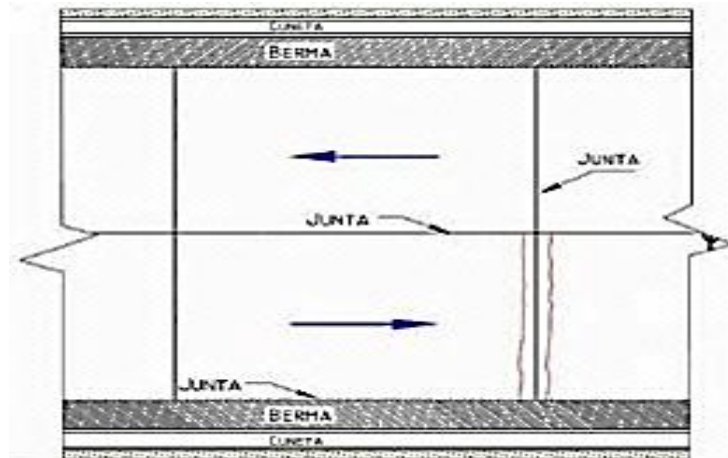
Vista en planta grietas extremos de los pasadores.
